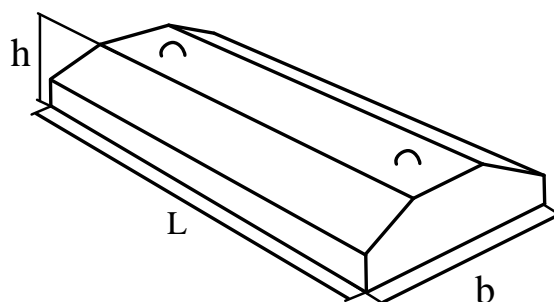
Плиты железобетонные ленточных фундаментов
